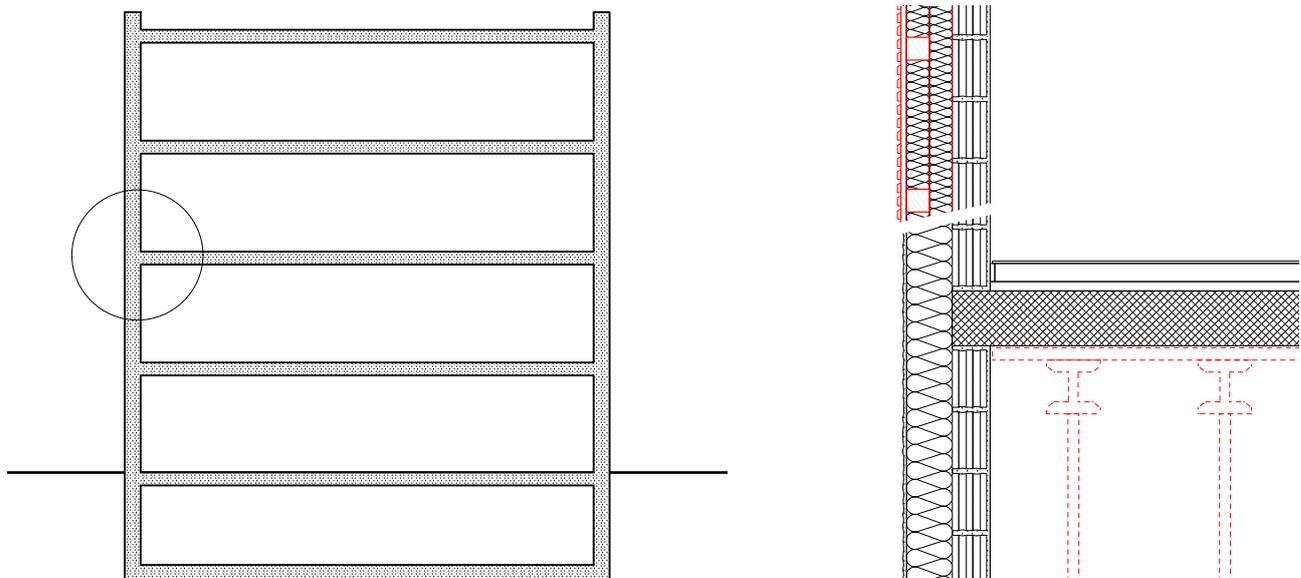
Wohnhaus nach der Erfindung von Stahlbeton
